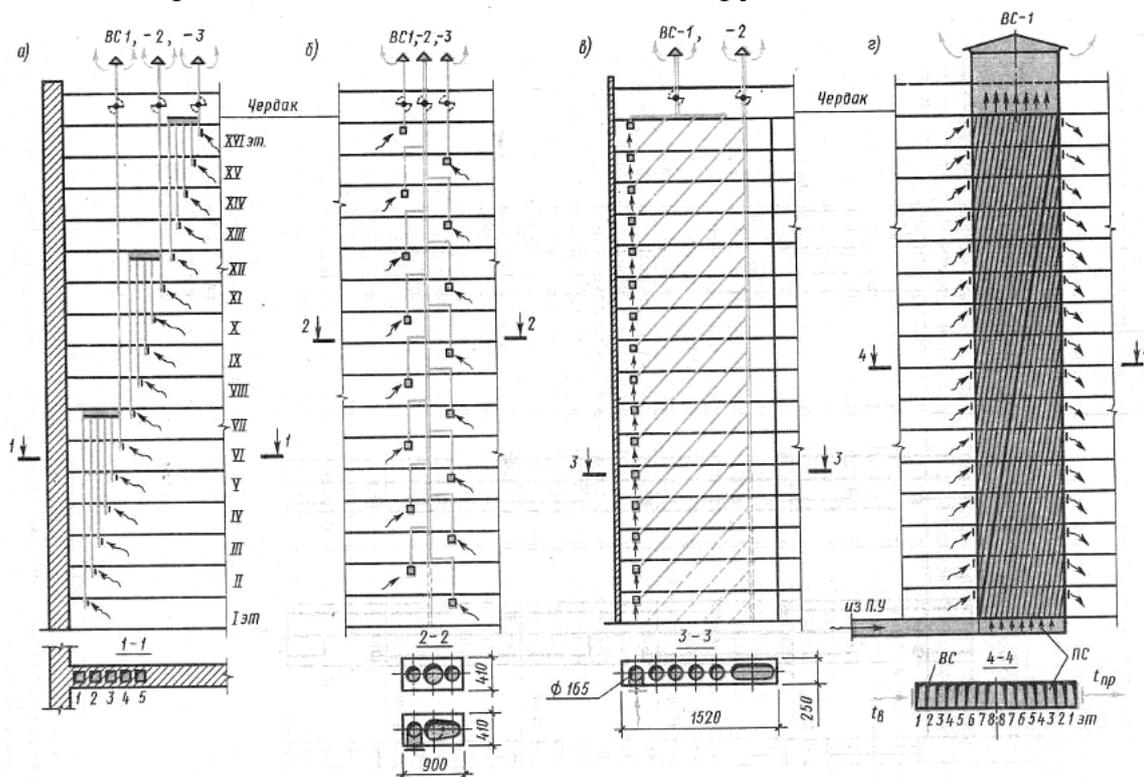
Принципиальная схема вентиляции высотного жилого здания:
